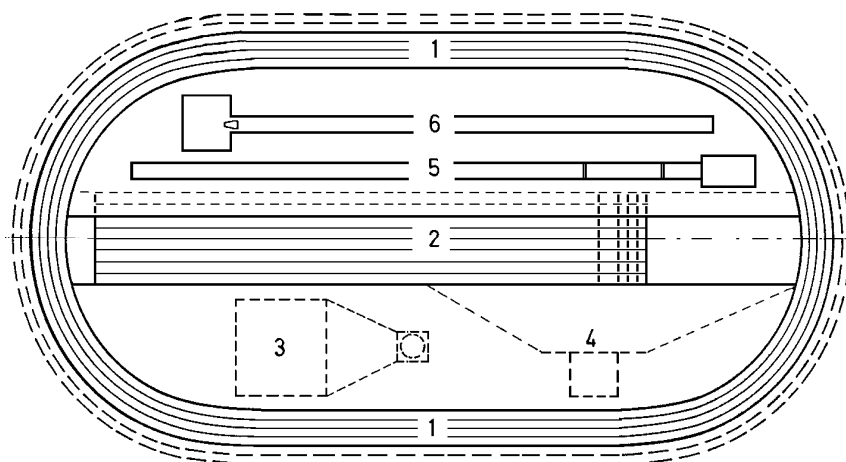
Plan de trazado de la Pista Cubierta Estándar de 200 m.
